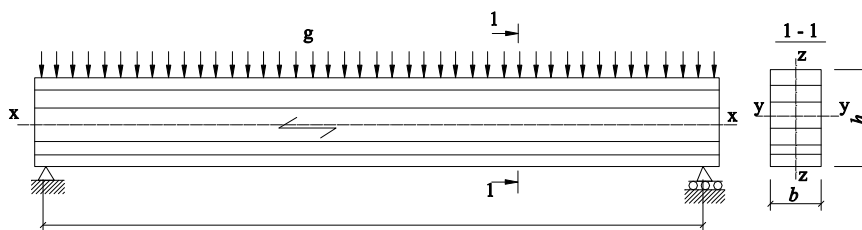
Расчетная схема изгибаемого элемента
